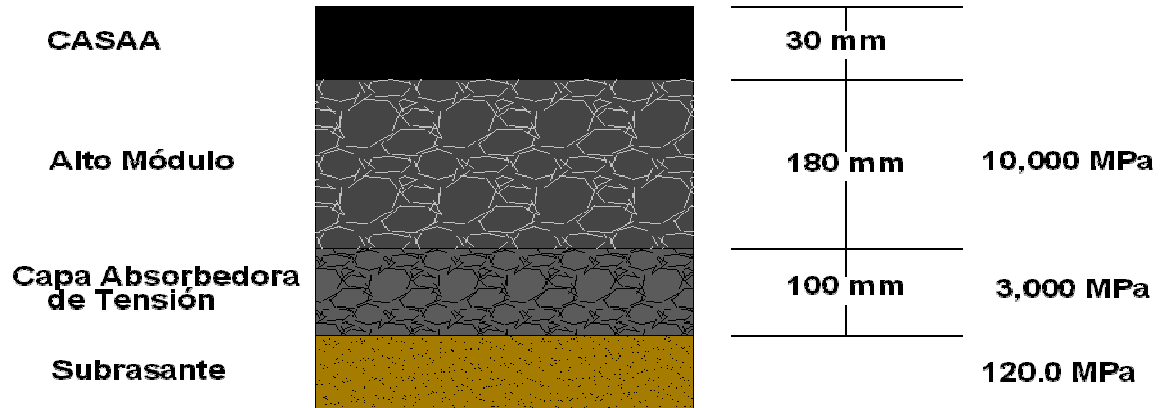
Estructura del Pavimento de larga duración del libramiento Dr. González en Nuevo León, México.
